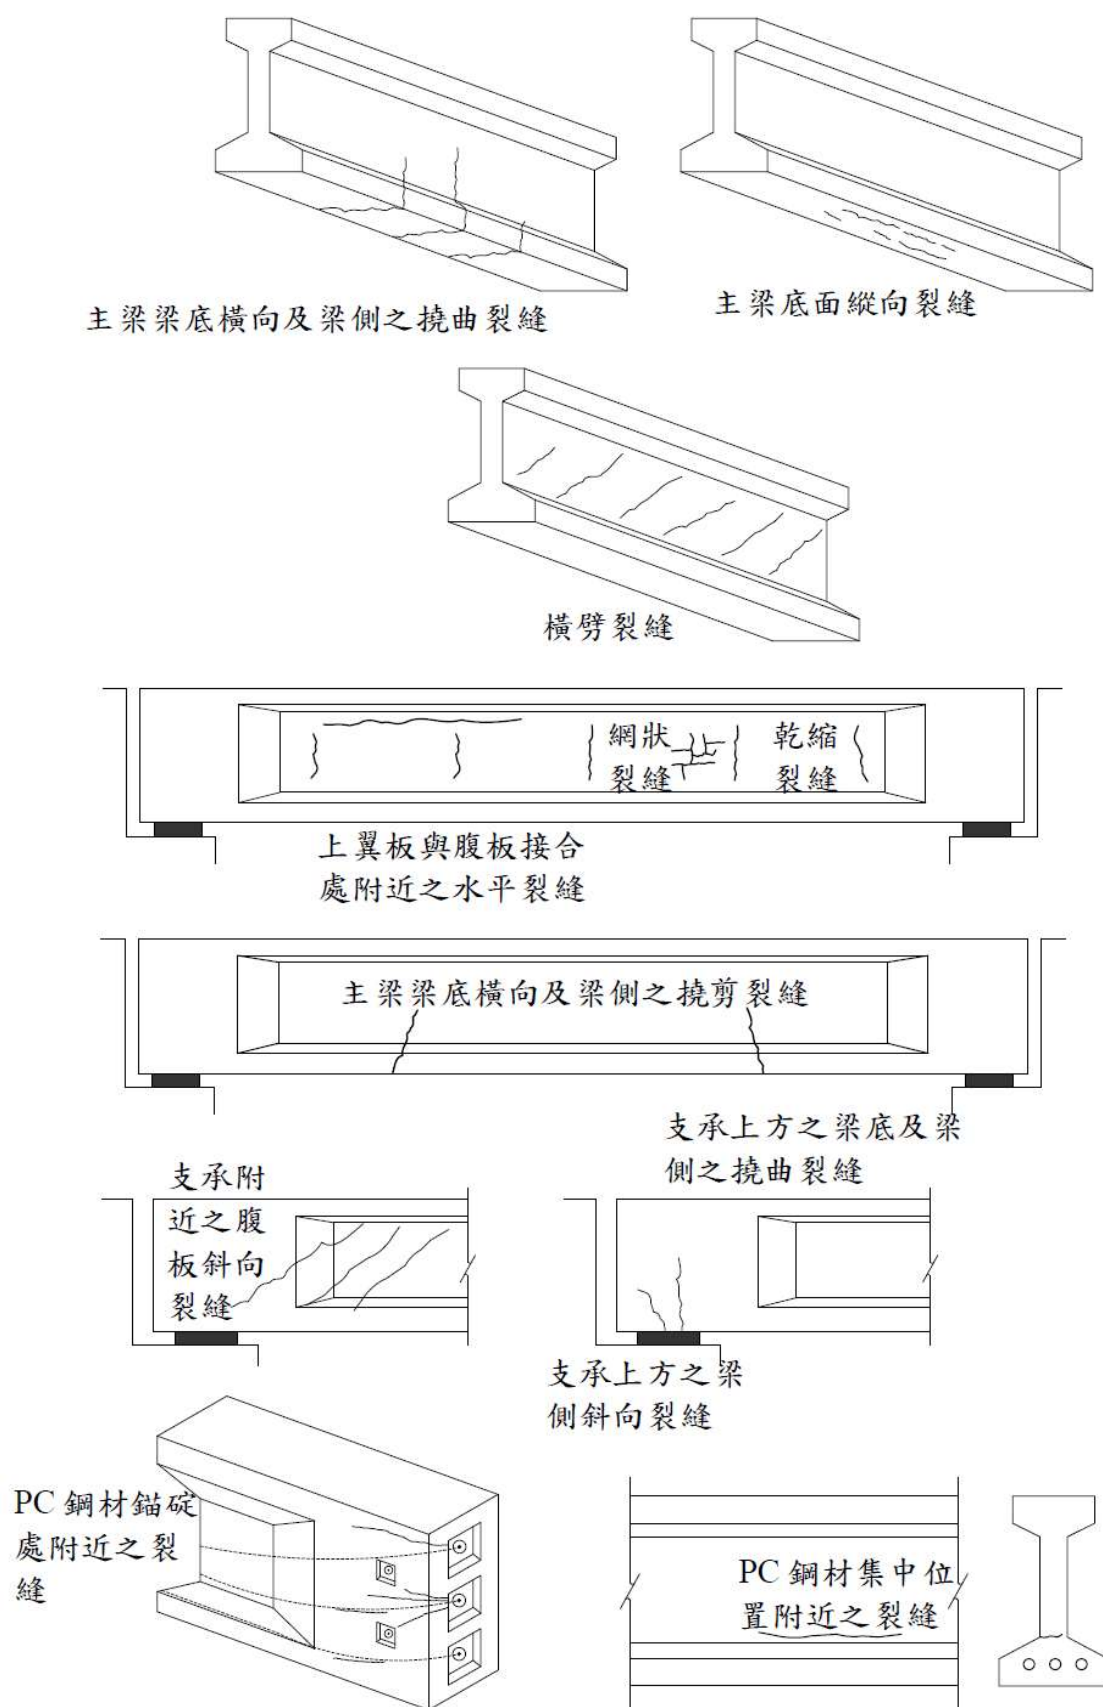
預力混凝土 I 型梁裂縫示意圖
